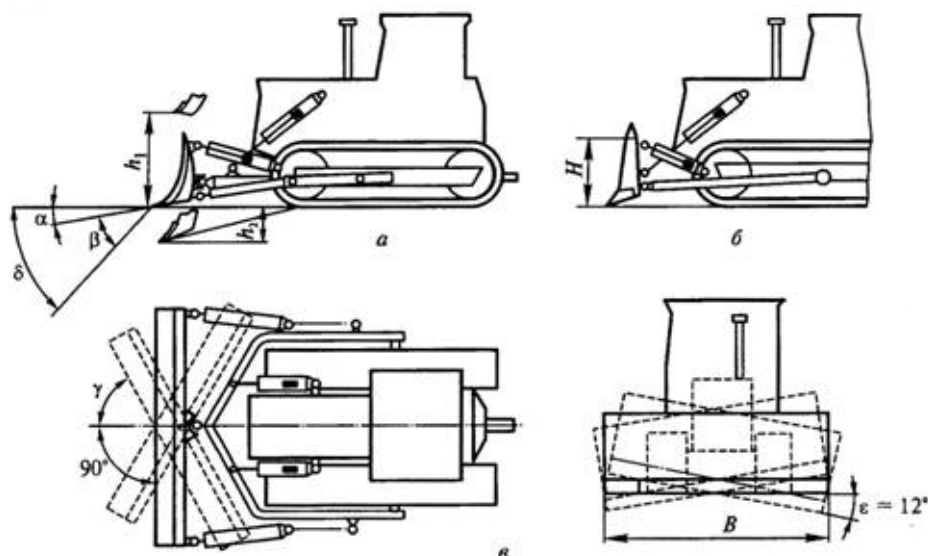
Схемы устройств и основные параметры бульдозеров: а - с поворотным отвалом; б - с неповоротным отвалом; в - поперечный перекус отвала.
